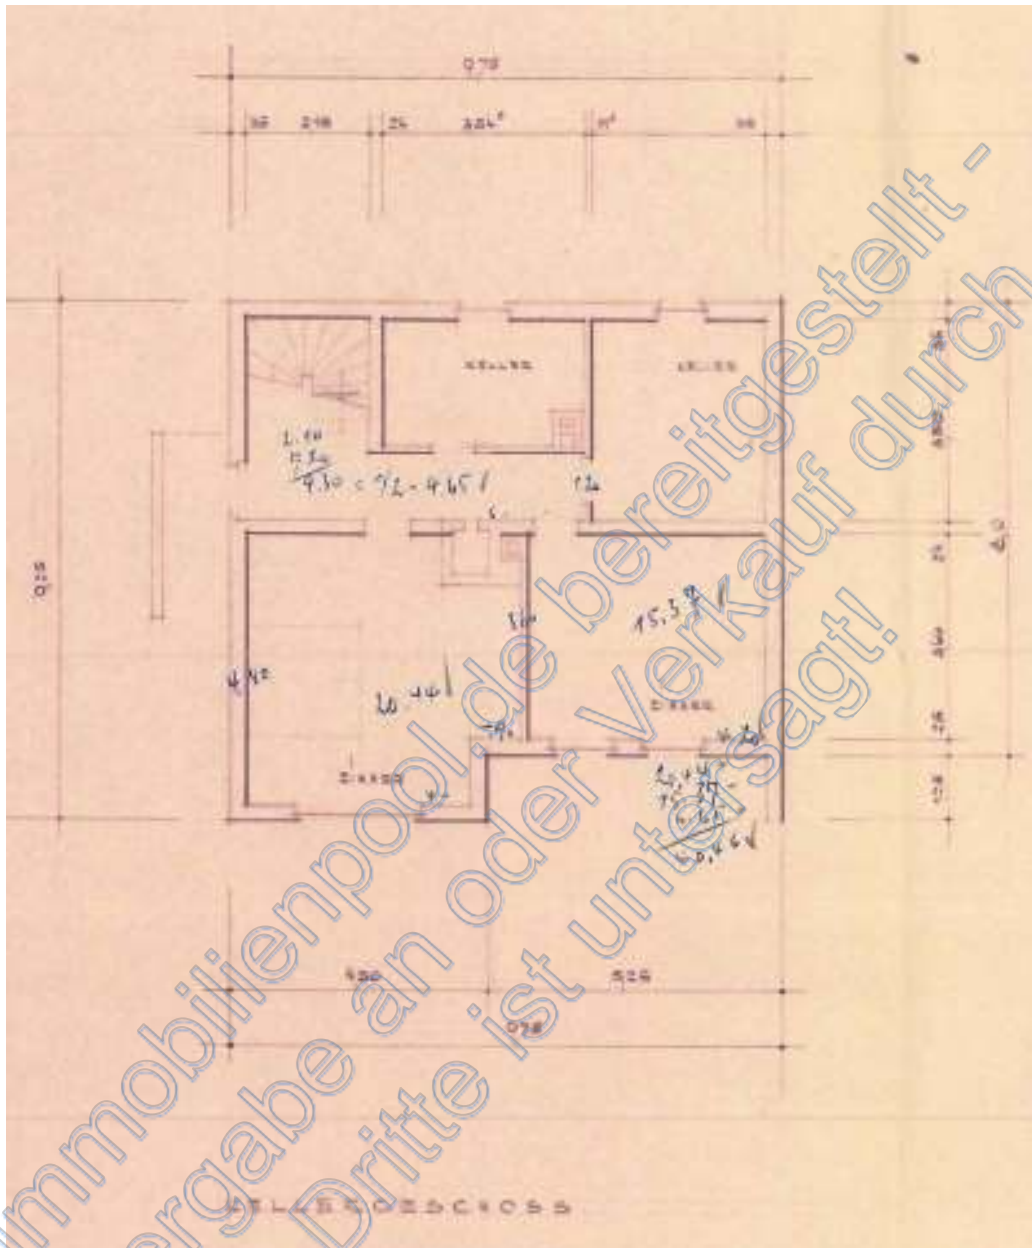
Bauzeichnung: Grundriss Kellergeschoss
